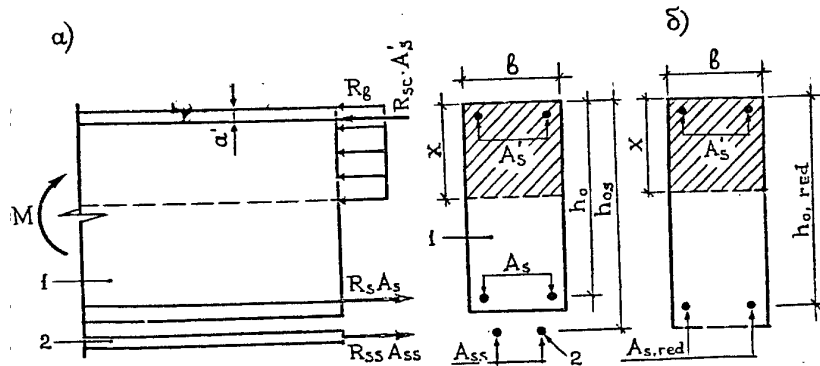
Расчетная схема нормального сечения, усиленного установкой дополнительной арматуры
